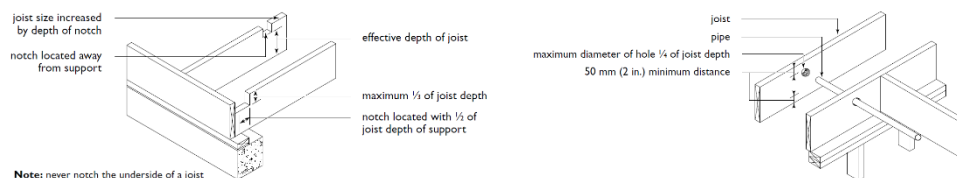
Passagem de infraestruturas e vigotas de pavimento (CMHC, 2013a).
